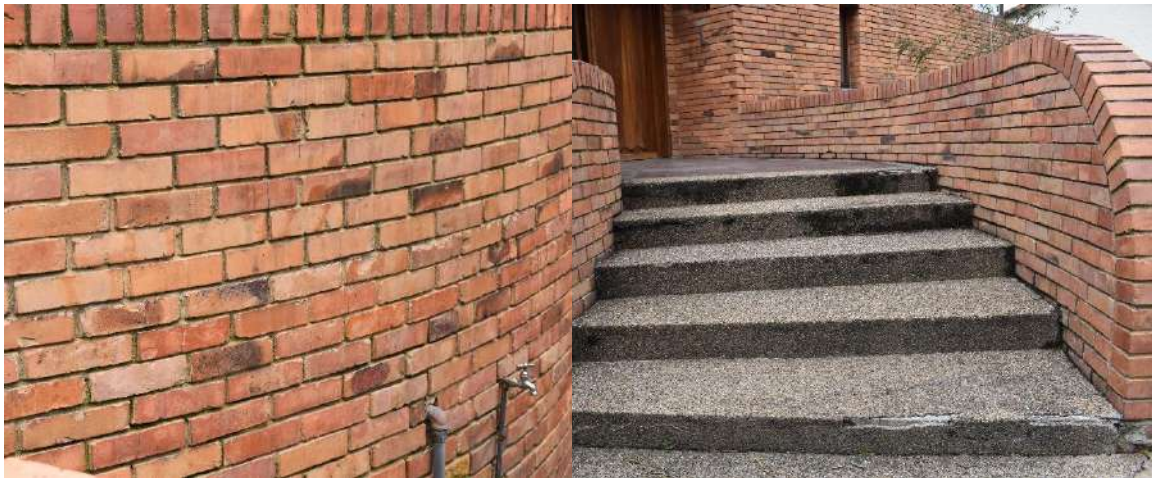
Fotografías detalles exteriores Casa Calderón. Fuente: Autora (2021).
